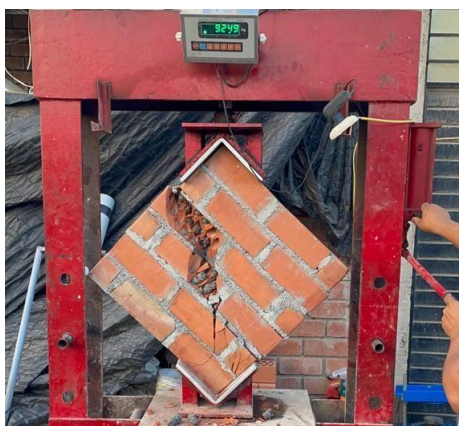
Murete con RTPC y %5CBCA alcanzo  $V'm=9249$  kg
